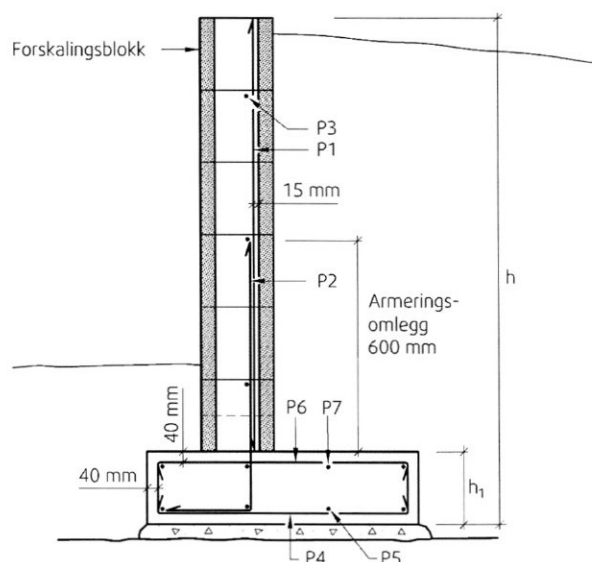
Plassering av betongarmering i utstøpt støttemur av Forskalingblokk.
